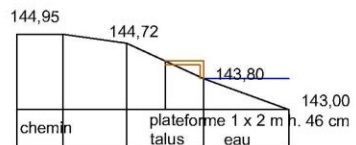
Plan de coupe 1 (source : commune de Lafrançaise)
